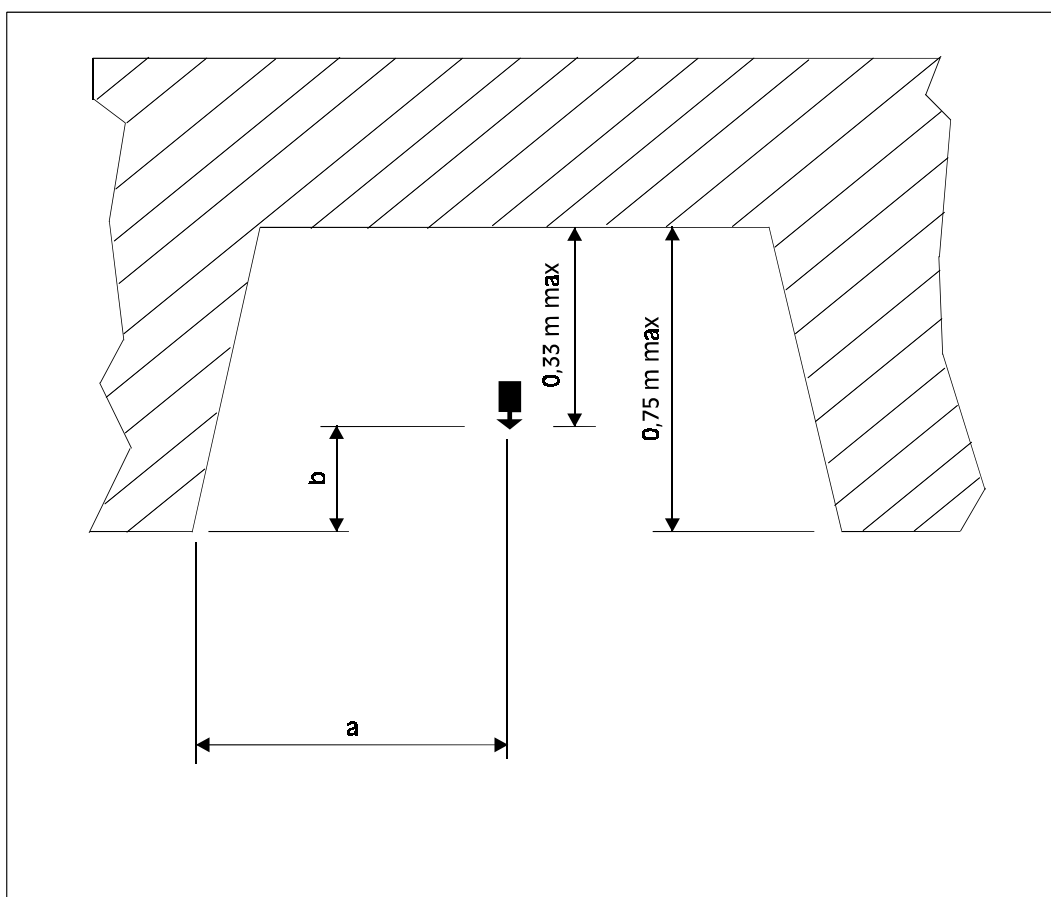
β : Protection ESFR - Position des sprinkleurs dans des caissons
